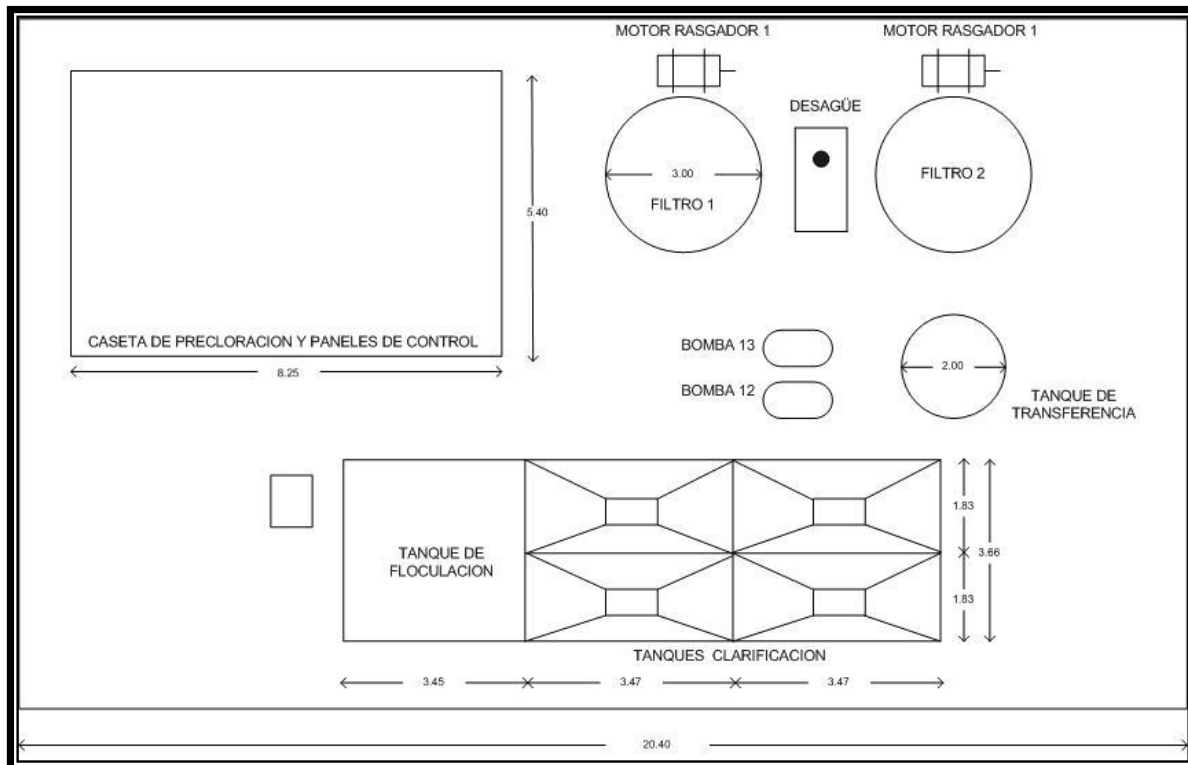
Croquis de localización del proceso de filtrado la planta potabilizadora
